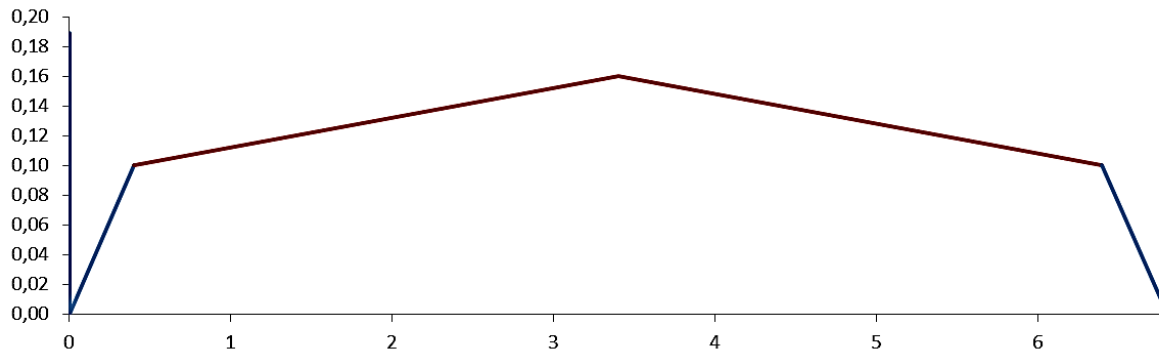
Sección típica de la vía, con las cunetas a los lados.
